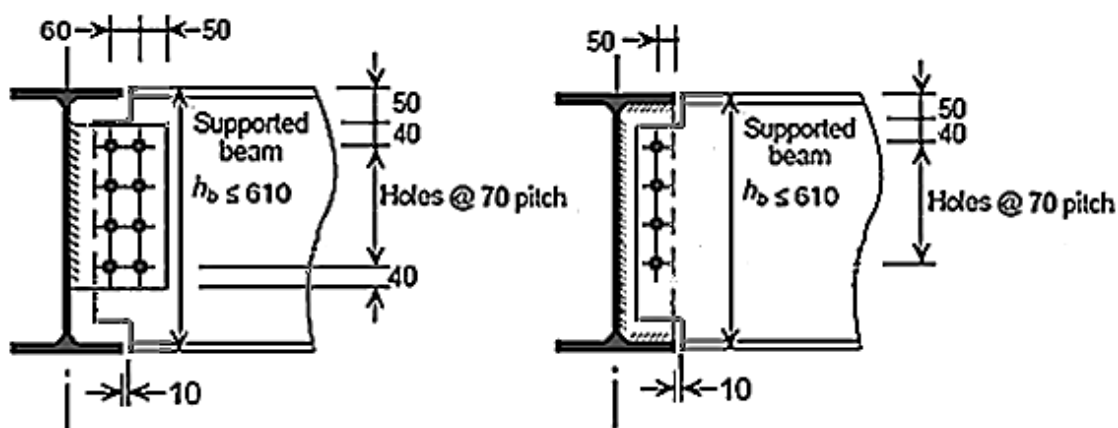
Detalhes de uma ligação standard: viga suportada com entalhes e viga de suporte utilizando chapas gousset (à esquerda), ou reforços (à direita); adaptado de (SCI/BCSA Connections Group, 2011)
